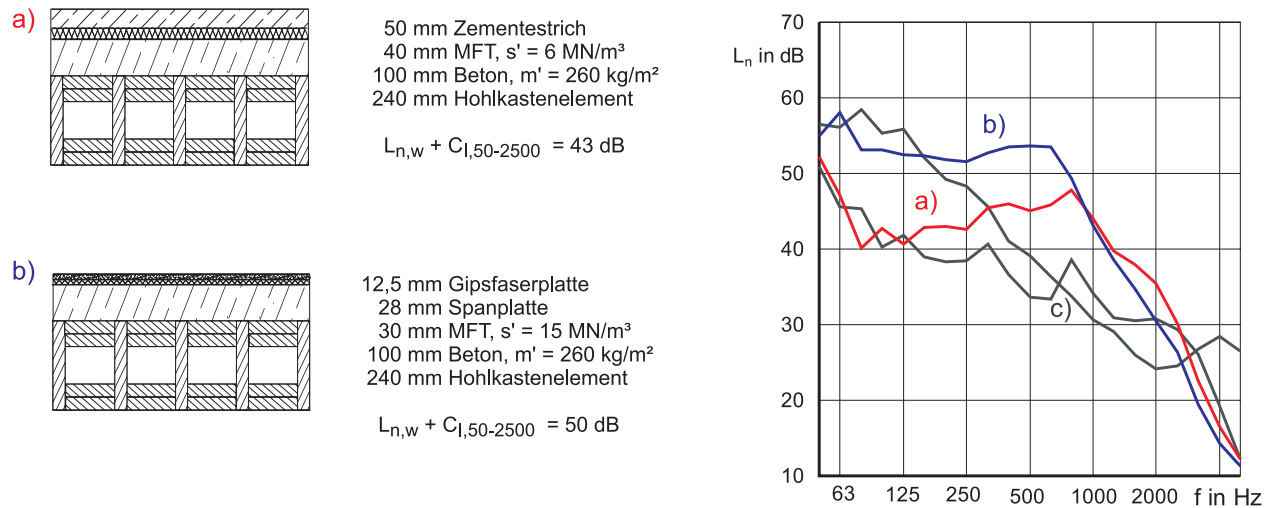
Messwerte der optimierten Holz-Beton-Verbunddecken im Vergleich mit konventionellen Stahlbetondecken: a) Holz-Beton-Verbunddecken mit Zementestrichaufbau b) Holz-Beton-Verbunddecken mit Trockenestrichaufbau c) Stahlbetondecken nach Abbildung 5.6
